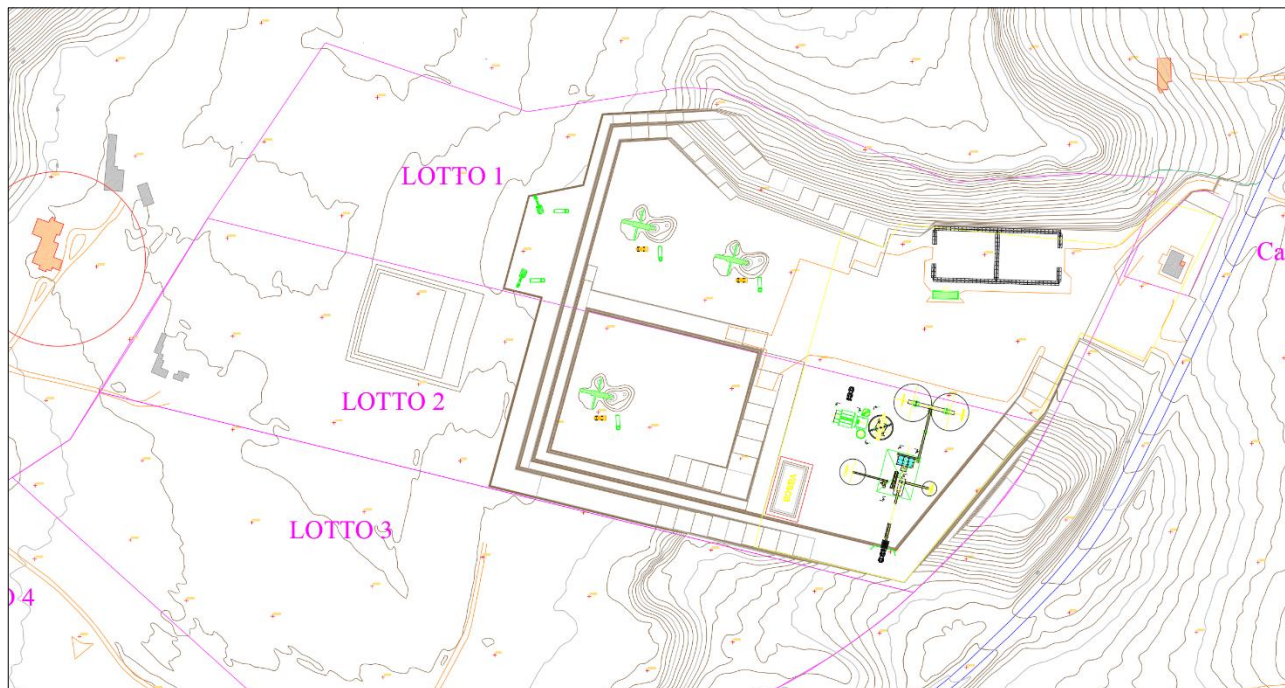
/A - Pianta di Progetto con ubicazione delle opere da realizzare
